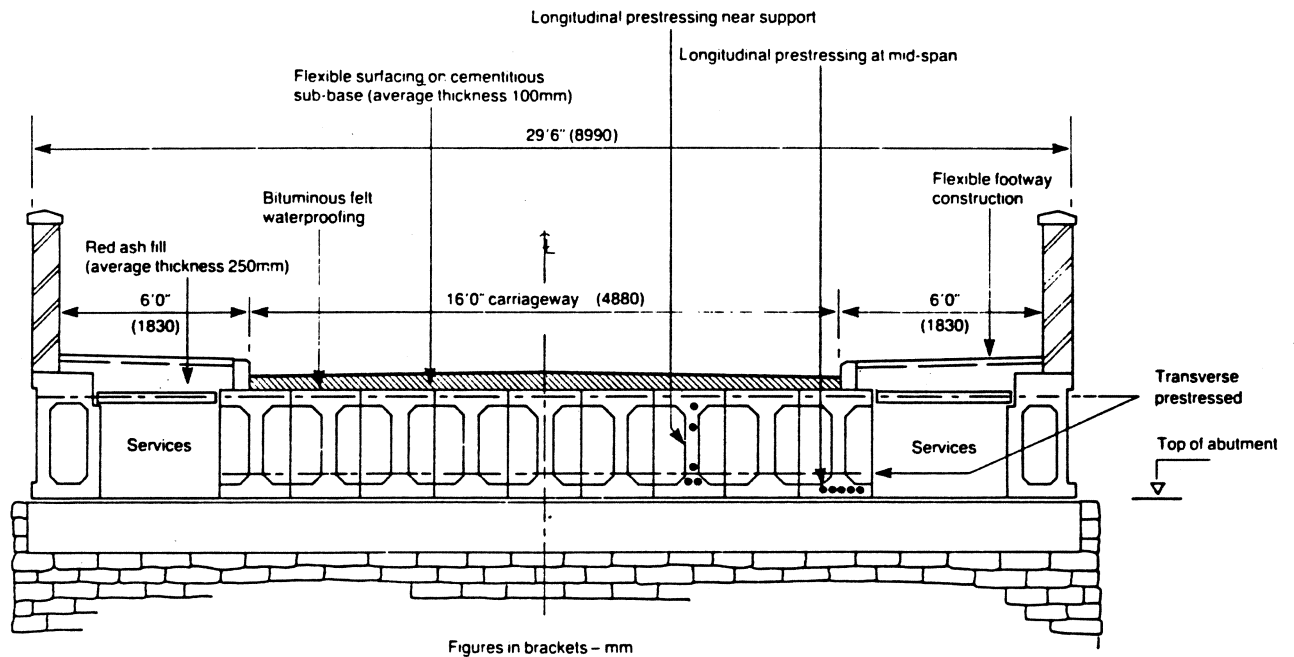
Ynys-y-Gwas-Brücke, Querschnitt mit 9 inneren und 2 äusseren Spannbetonträgern, mit Spanngliedern längs und quer vorgespannt.
